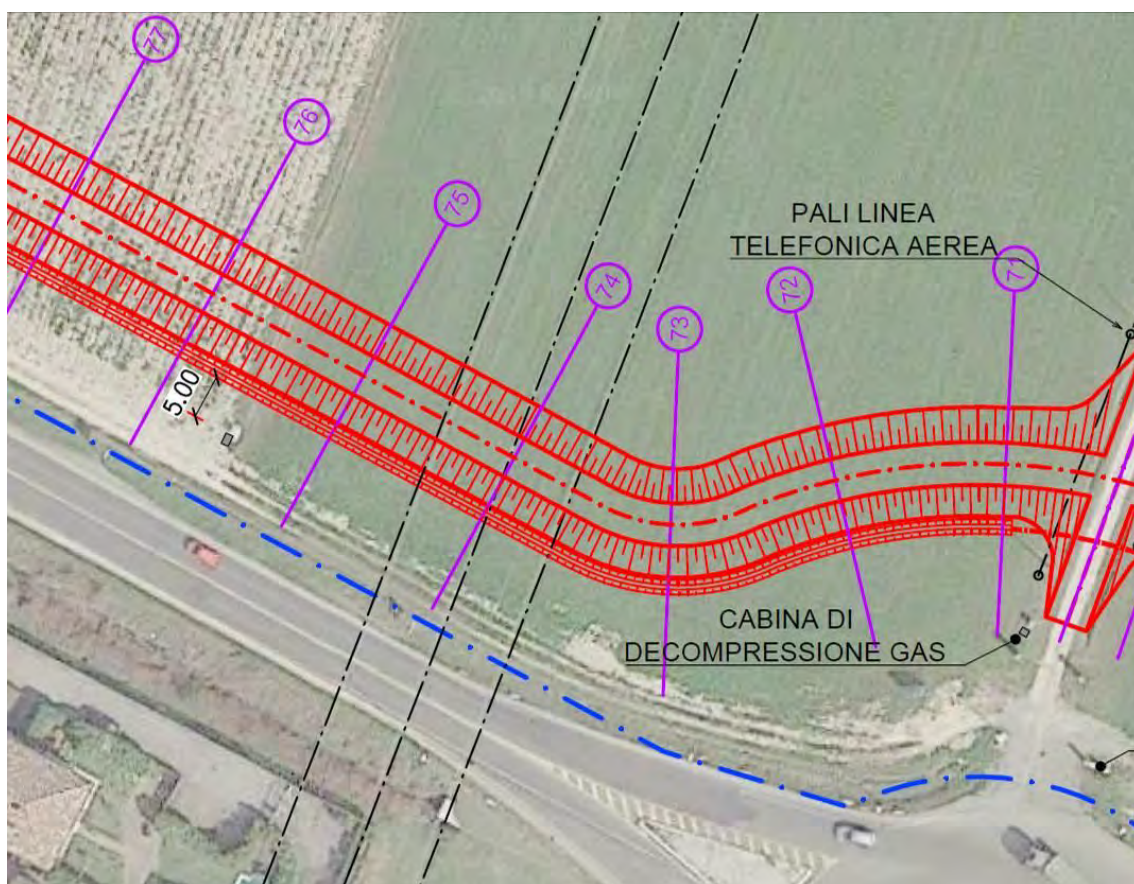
posizione linea elettrica Terna 380 kV (stralcio planimetria di progetto).
